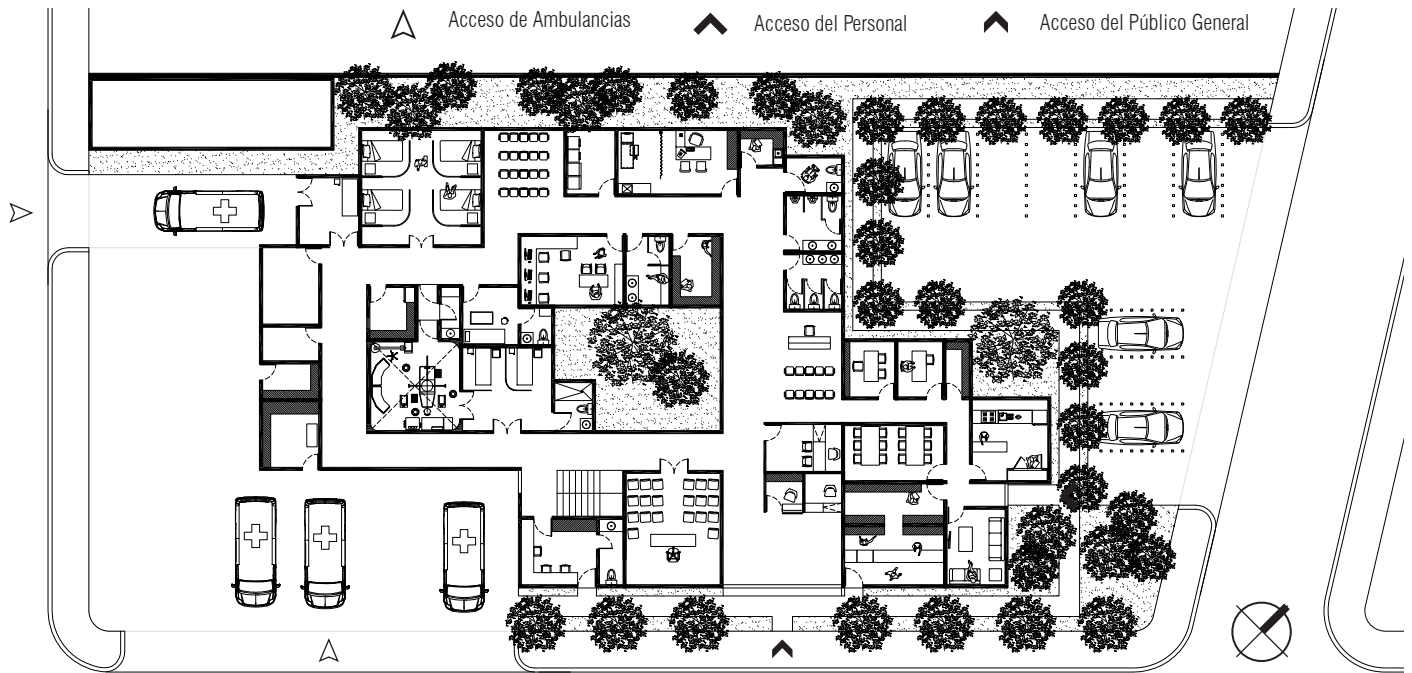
| Prototipo Delegación Media para el grupo climático uno | Planta Baja
